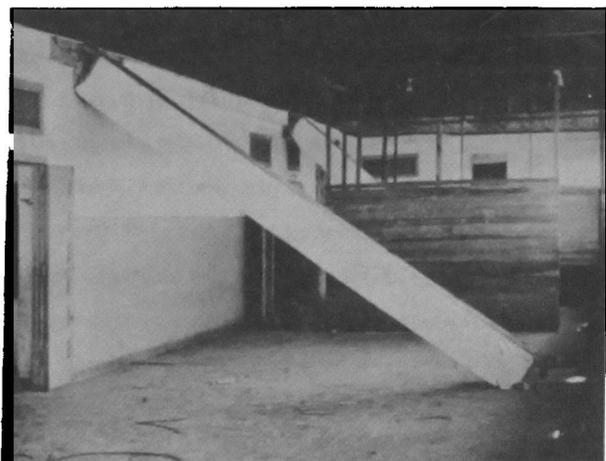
Colapso de viga por defecto de anclaje. Escuela de Purranque.
